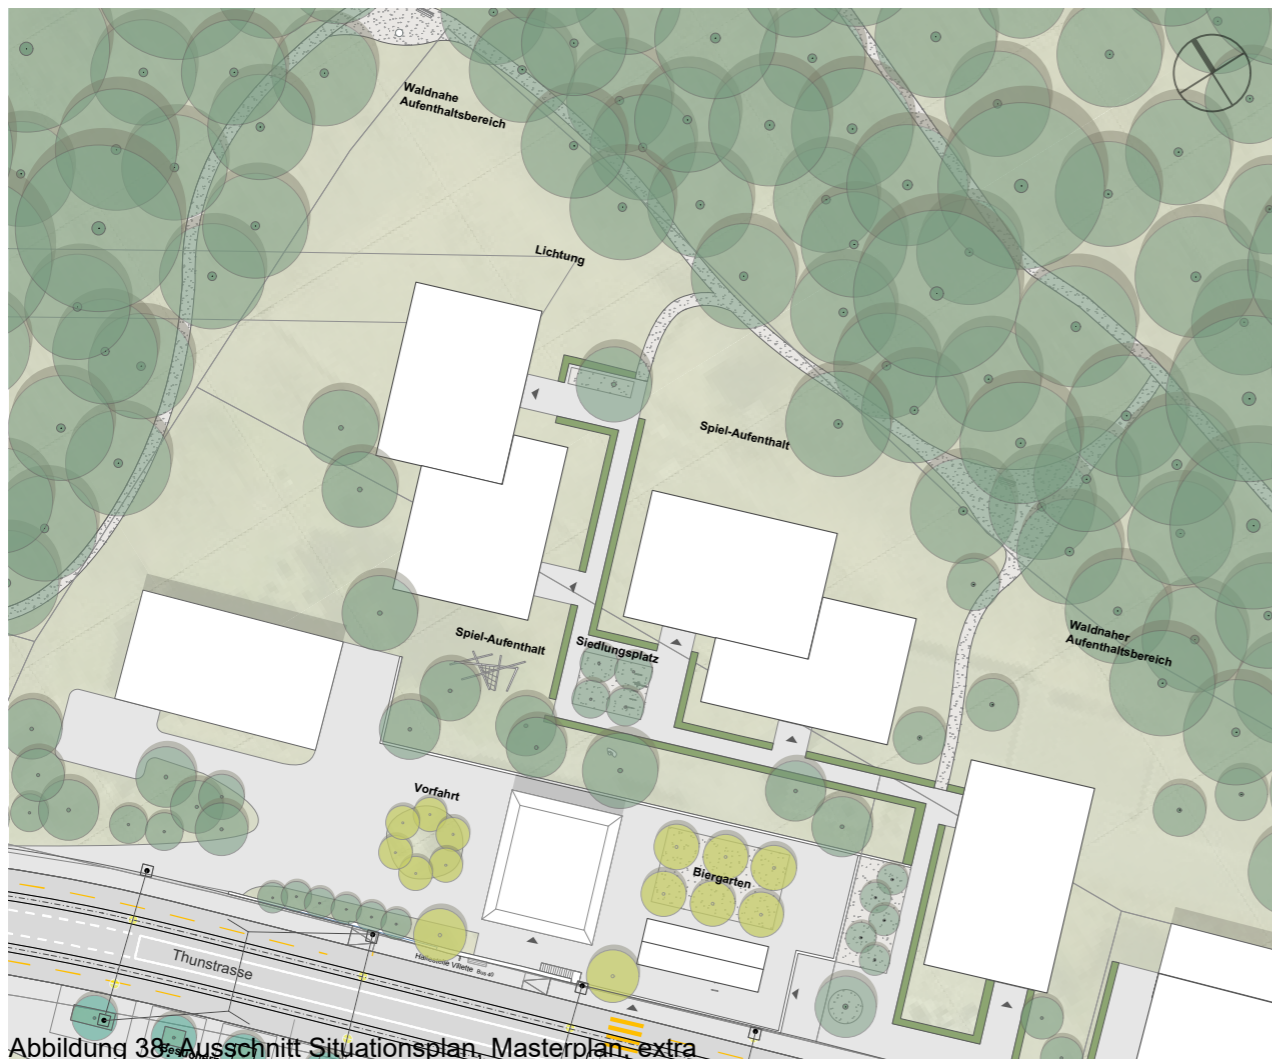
Ausschnitt Situationsplan, Masterplan, extra
